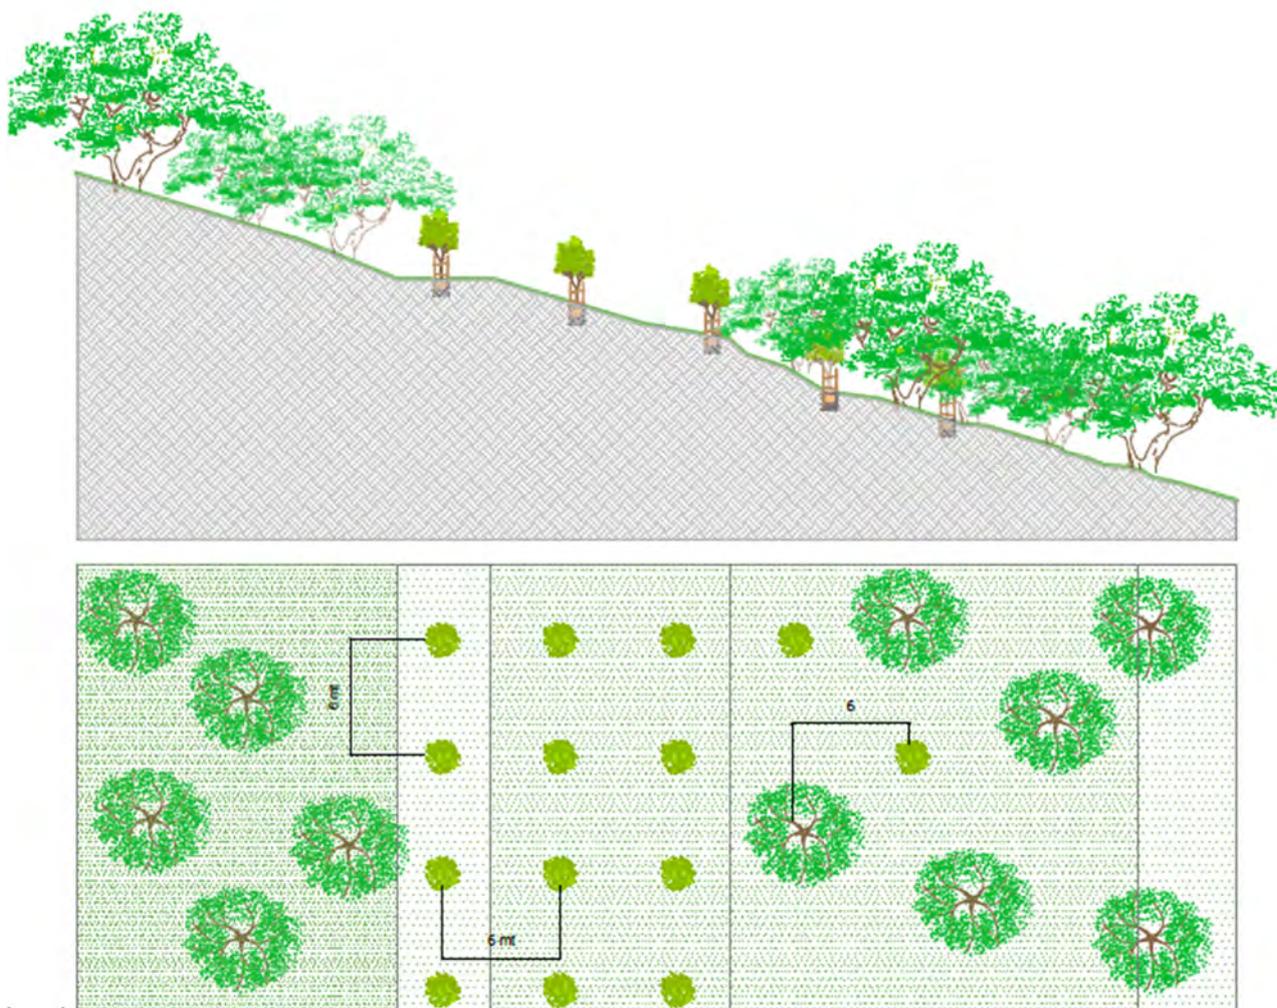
Planimetria del sesto d'impianto a quadrato delle 680 piantine di sughera da mettere a dimora.
